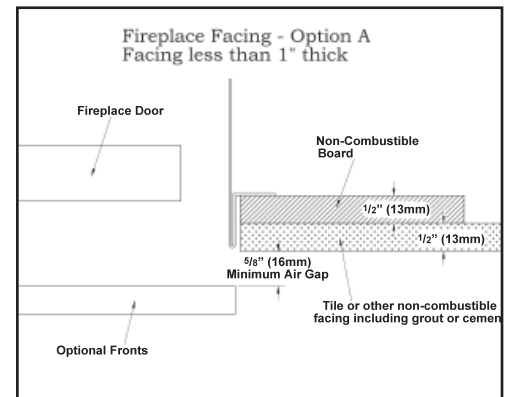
Option 1 - Revêtement moins de 1" (25.4mm) d'épaisseur avec la façade optionnelle installée.
